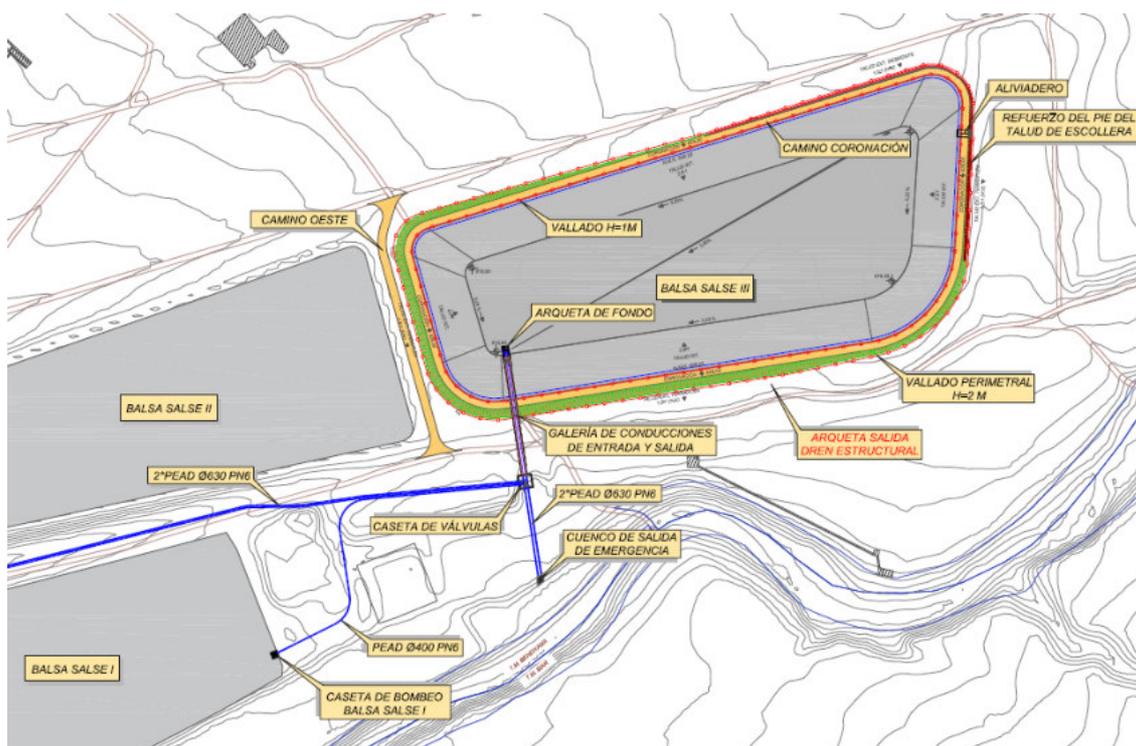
Encaje de la balsa con un talud máximo de 4,90 m de altura. Fuente: Elaboración propia.
